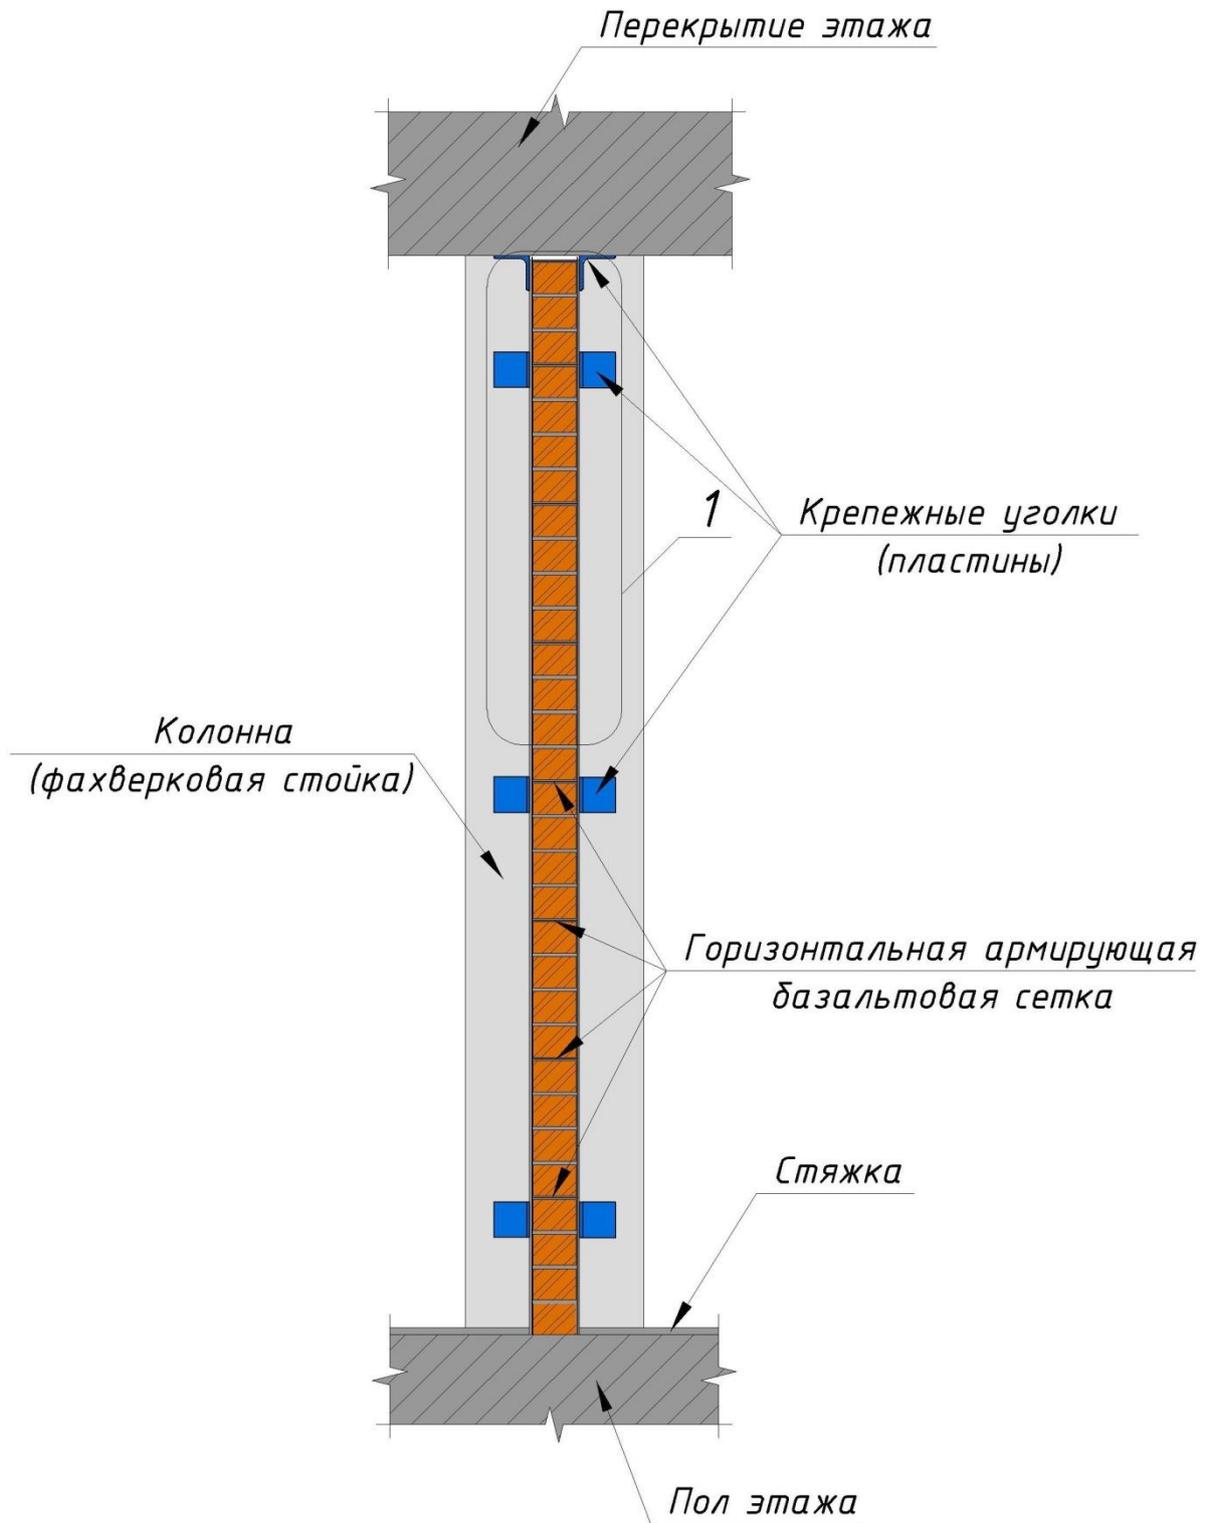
Схема крепления кирпичной перегородки, усиленной базальтовой сеткой, к каркасу здания
